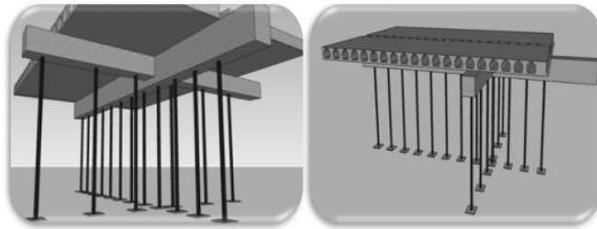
Vista en 3d de la colocación de puntales para el sistema de losas pretensadas. Del autor
